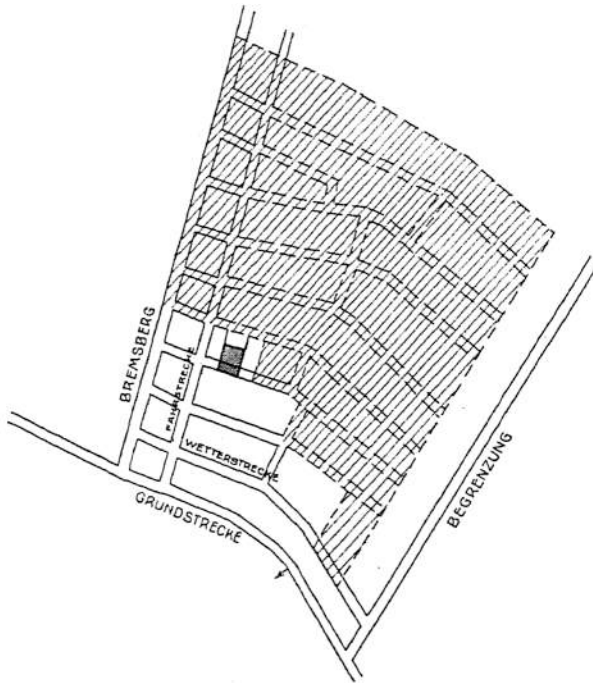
Streichender Pfeilerbau mit schwebenden Abschnitten.
